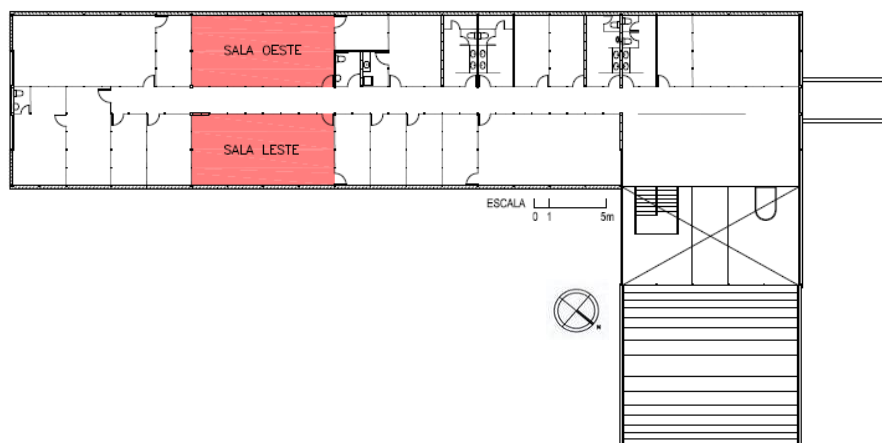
Planta esquemática do segundo pavimento com a localização das salas para a realização das medições.
